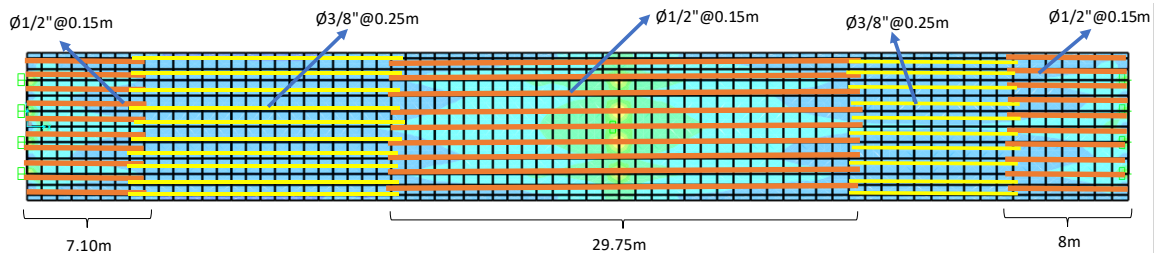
Distribución de acero de refuerzo superior longitudinal en losa
